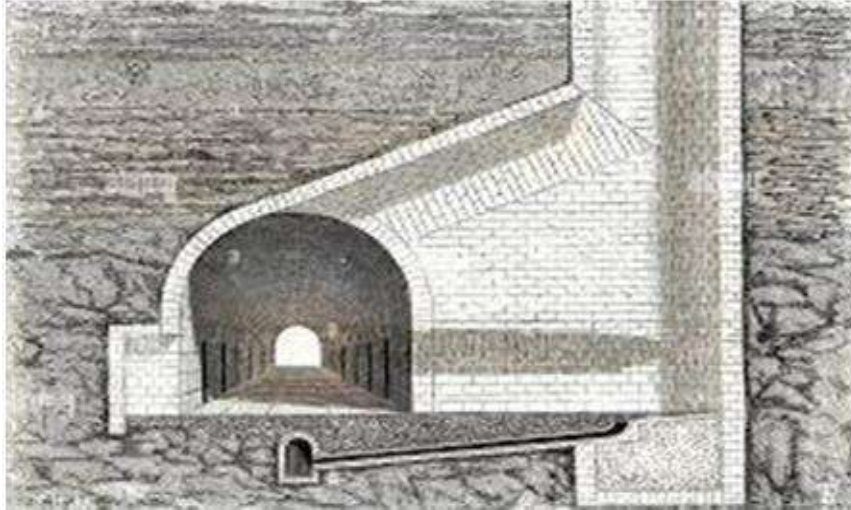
Coupe transversale dans un tunnel avec un puits d'aération
